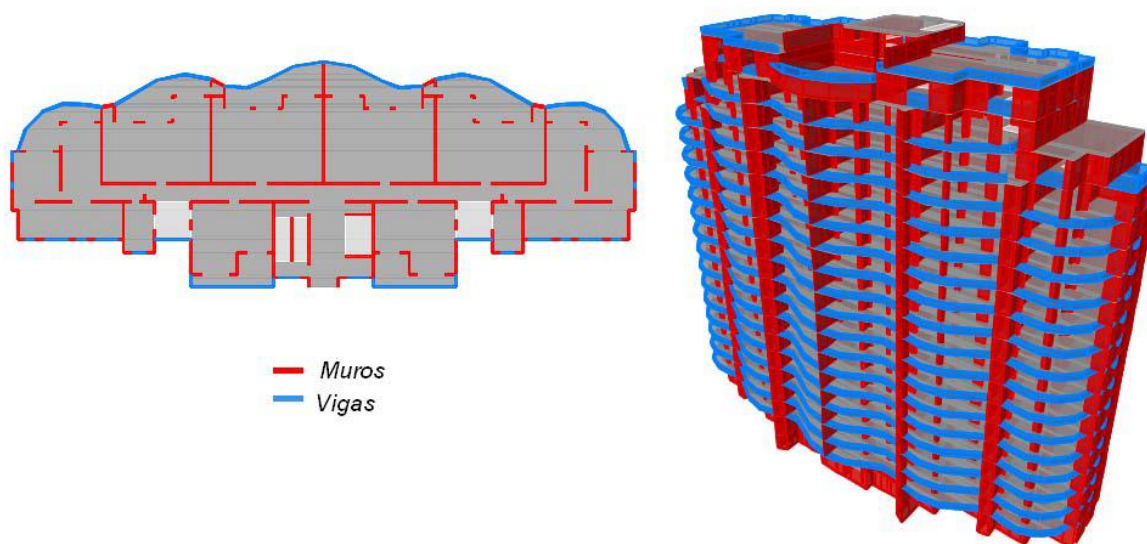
Vista planta segundo piso y vista modelo 3D ETABS [20]
